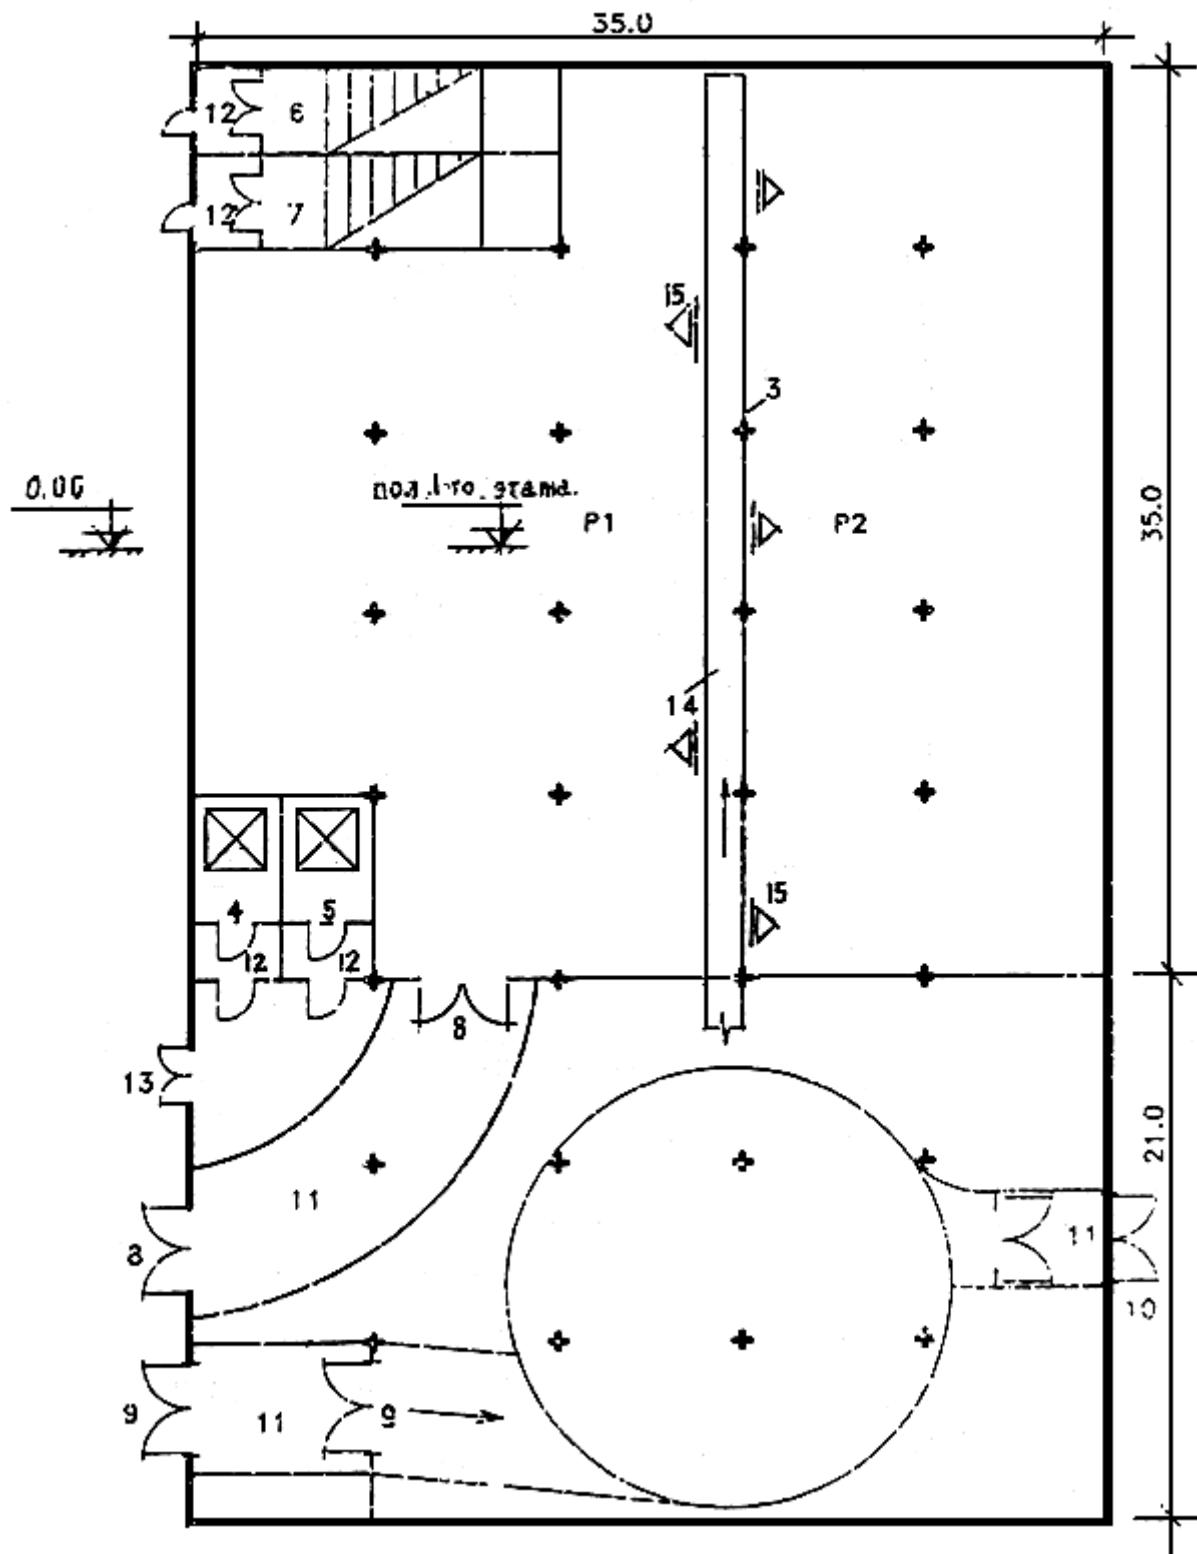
План на отм. пола 1-го этажа. Входы и выходы, показанные на плане, соответствуют отм. 0.00.
